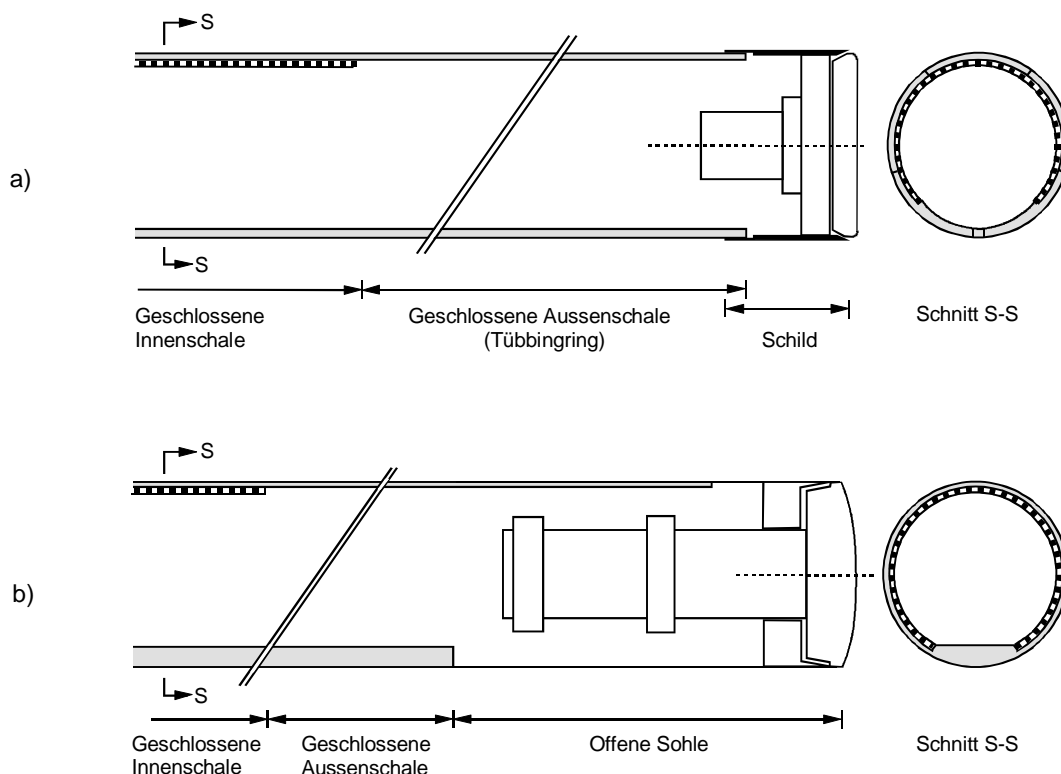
Maschineller Vortrieb mit zweischaligem Ausbau (Beispiele)
